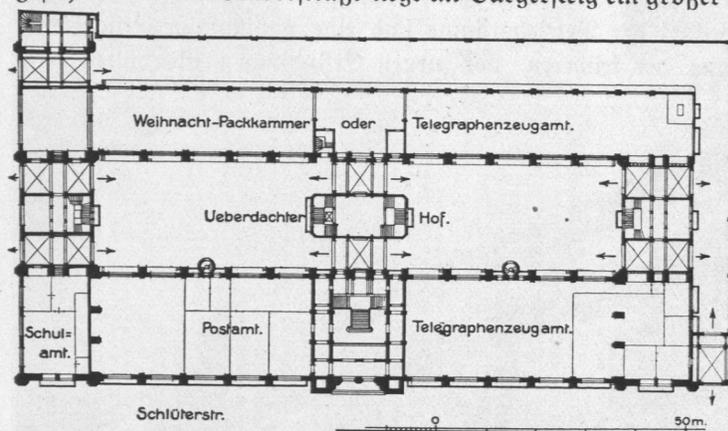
Fernsprechgebäude, Erdgeschoß, Grundriß.
